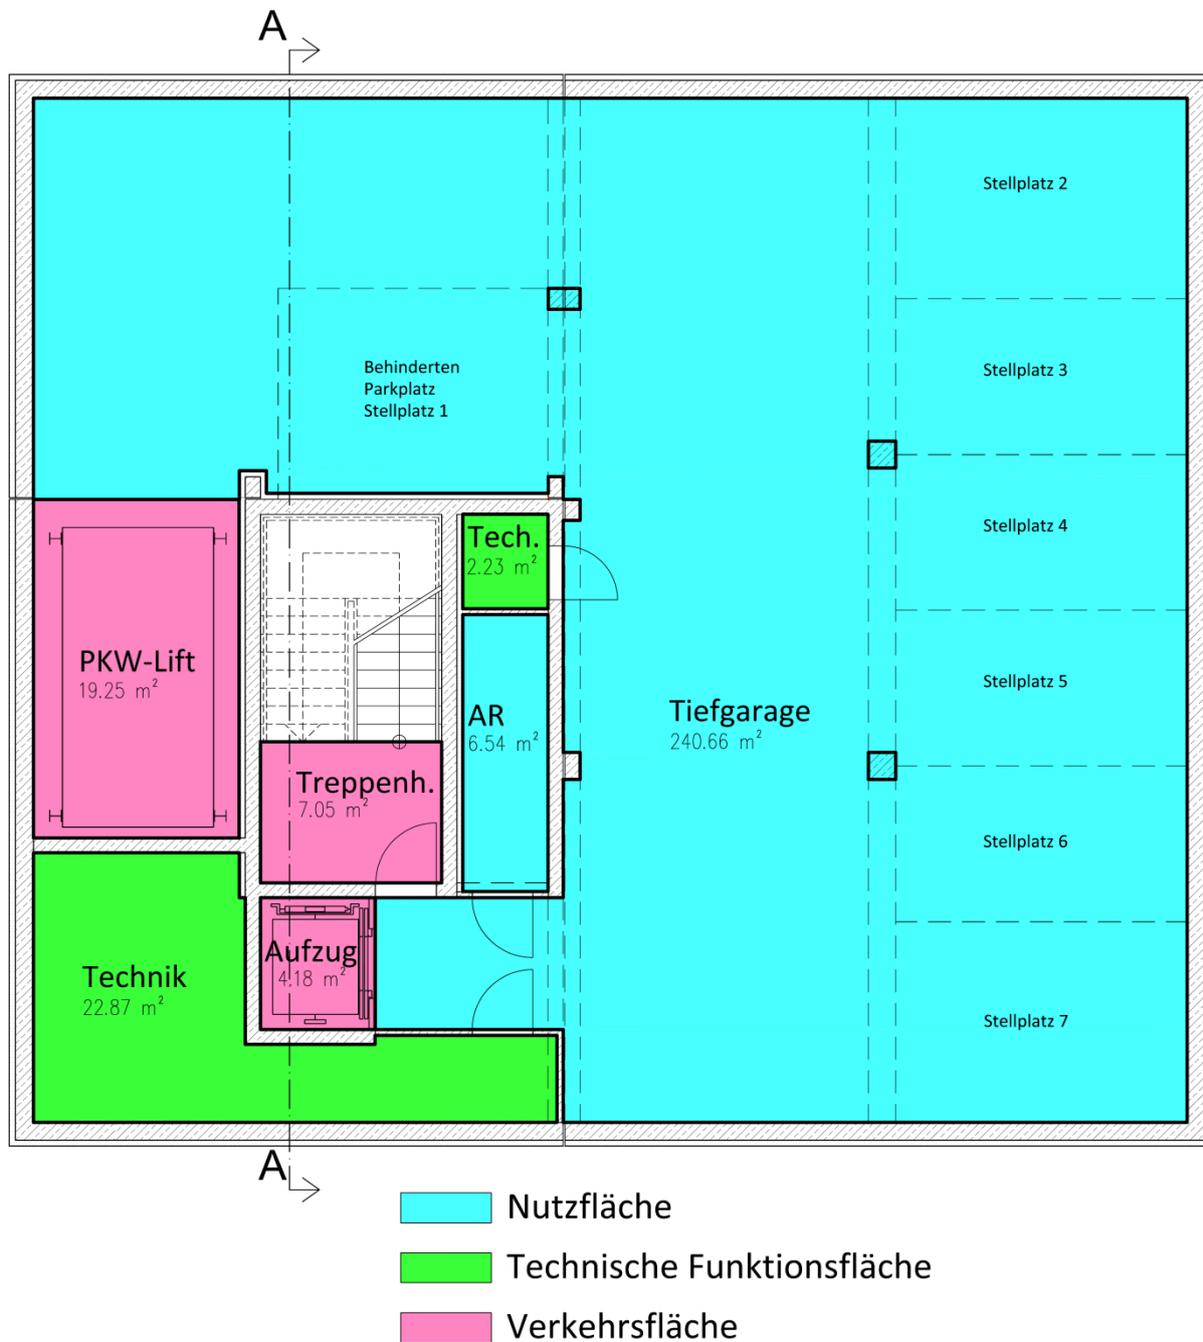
Flächenplan – Grundriss KG
